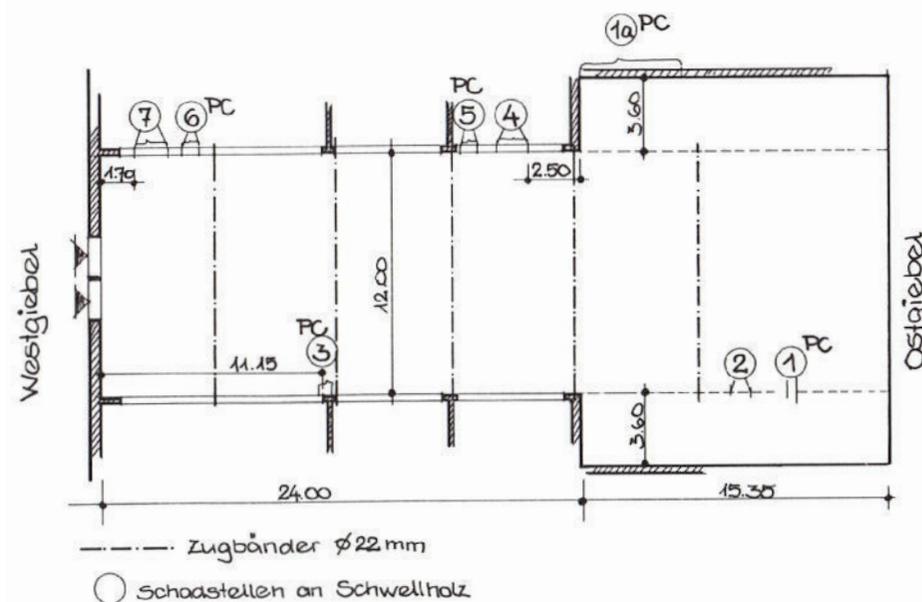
Dickhäuterhaus, Zoo Leipzig, Grundriss
